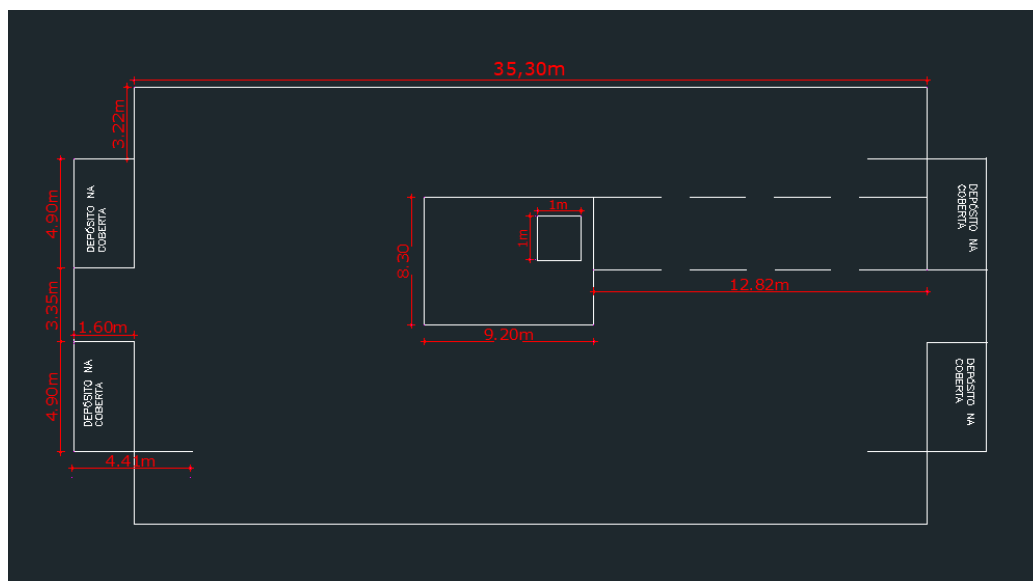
Desenho esquemático com as medidas reais do perímetro do Chapim de Granito no Pavimento da Cobertura
